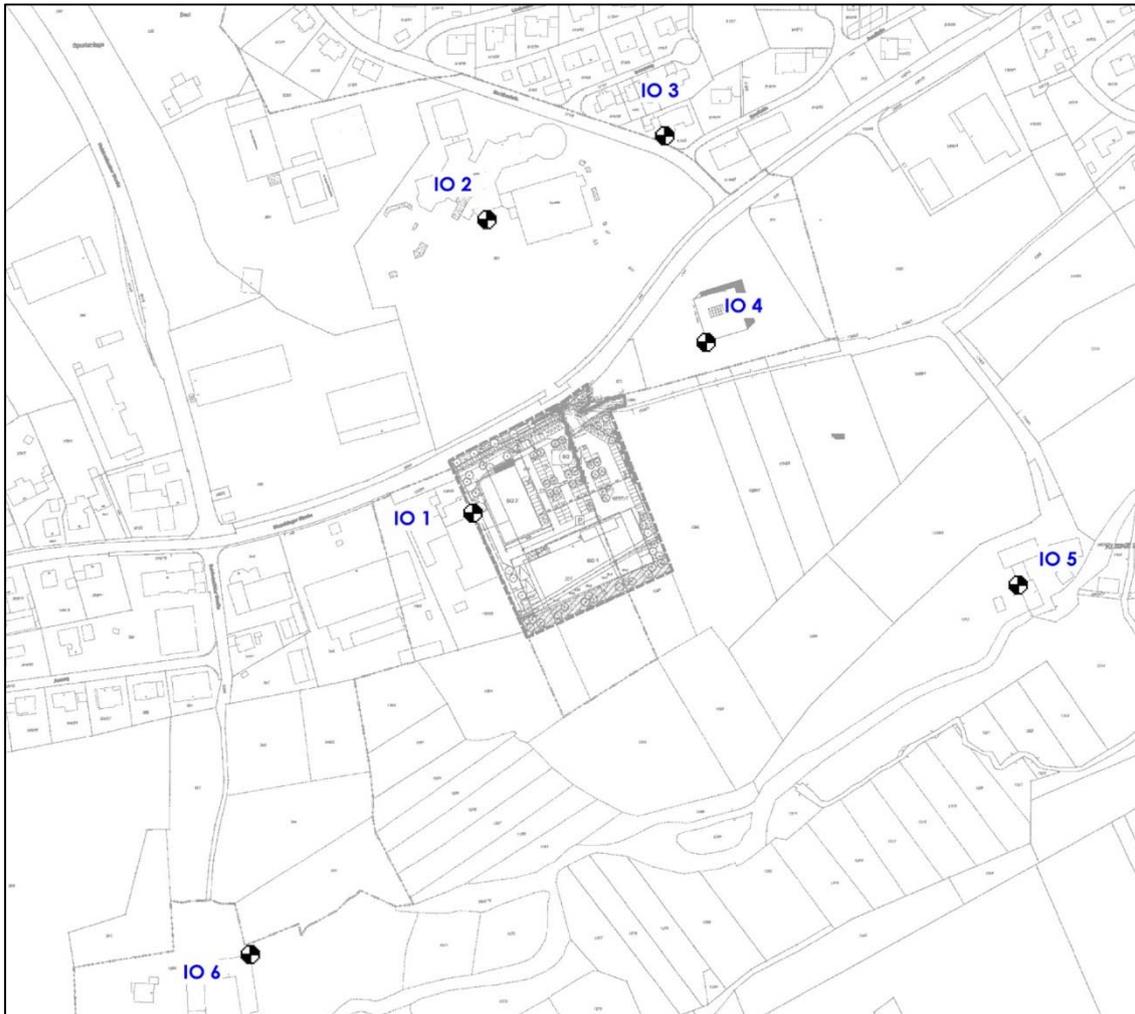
Lageplan mit Darstellung der maßgeblichen Immissionsorte (IO)
